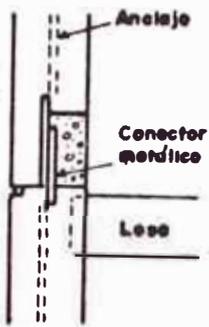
(a) Junta Horizontal de Paredes Portantes
